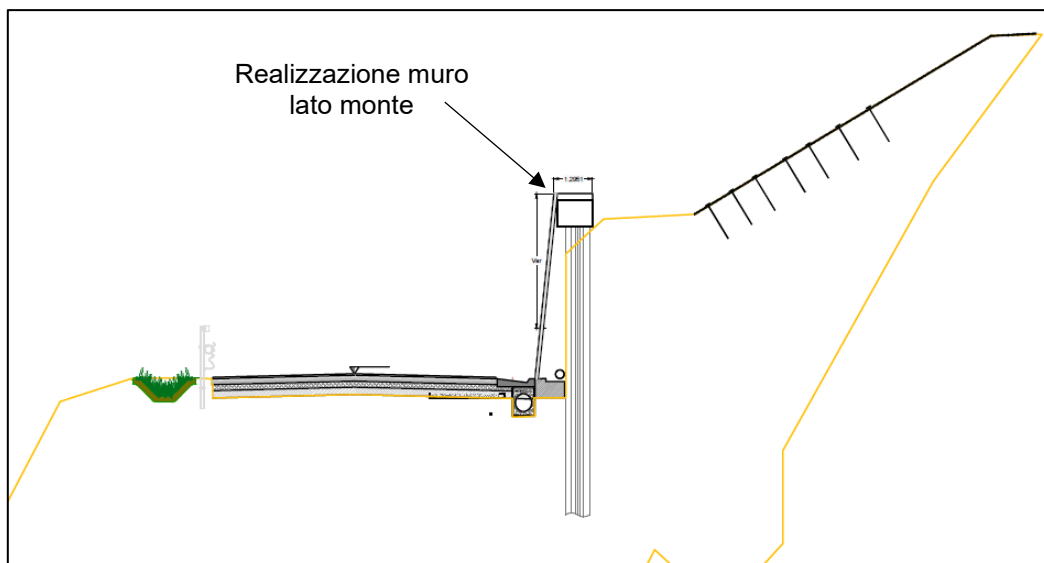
Sezione tipo 5 – Allargamento carreggiata con realizzazione di muro con pali lato monte
